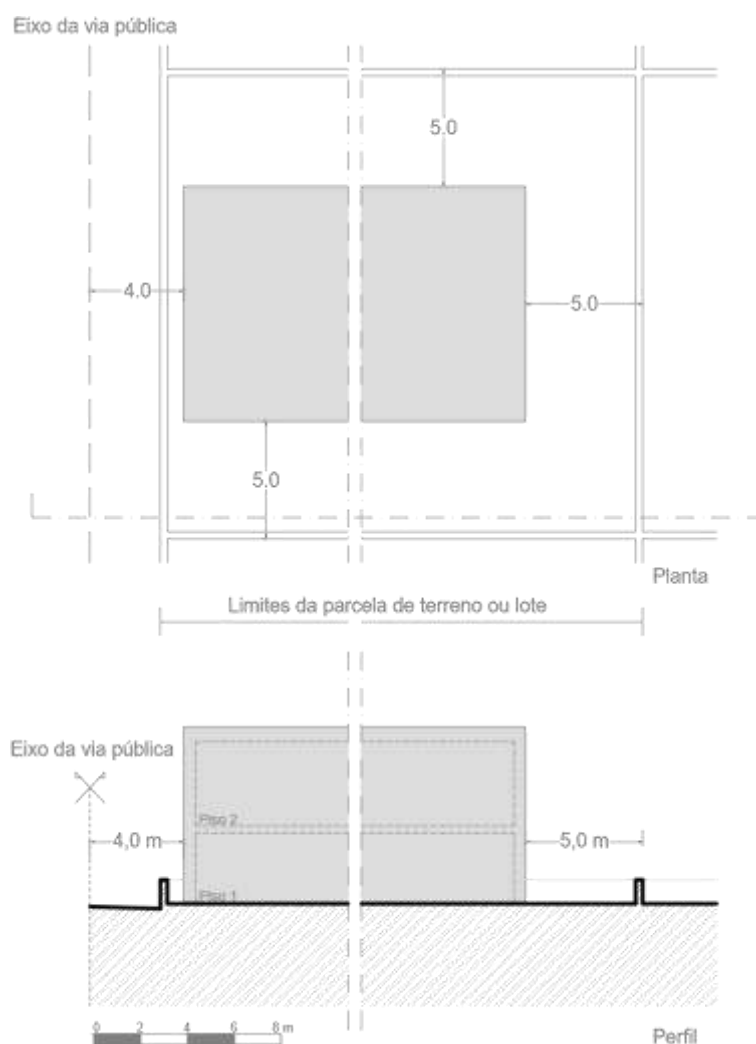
Planta e perfil transversal do caminho vicinal (afastamentos)
